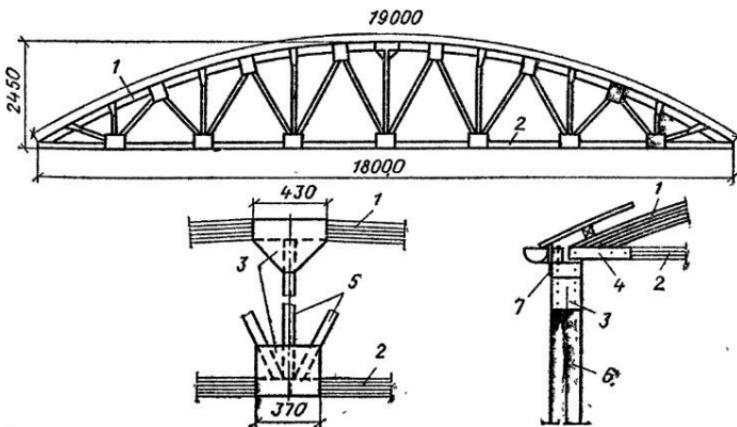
Гнуто-клеенные из досок дугообразные (сегментные) фермы со стальными пластинками для скрепления узлов
